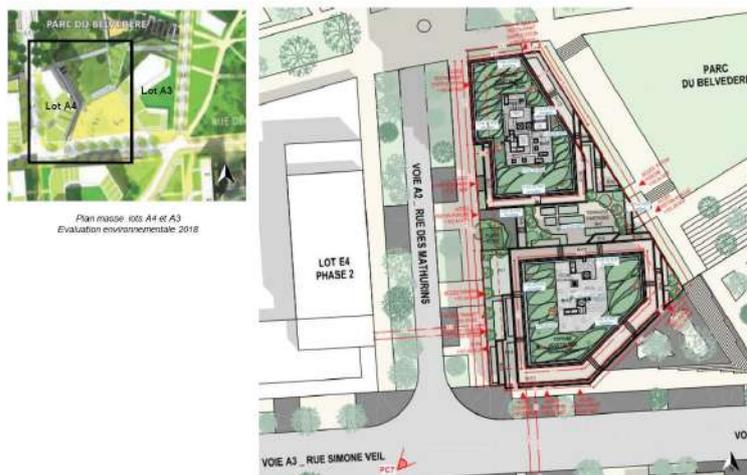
Plan masse du lot A3 p.162 étude d'impact
